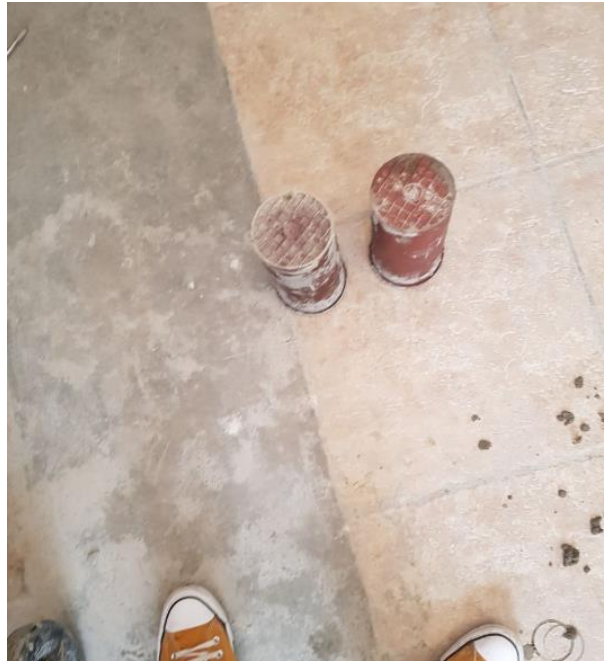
Pasa las 24 horas de las probetas de concreto cilíndricas, se realiza el desencofrado.
